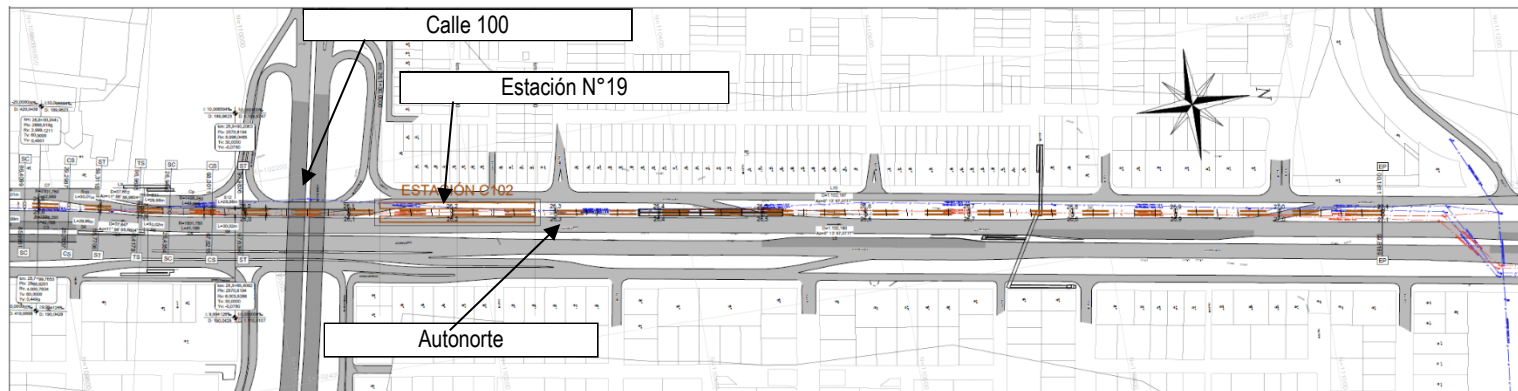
Trazado EPLMB, Tramo calle 100 Norte
